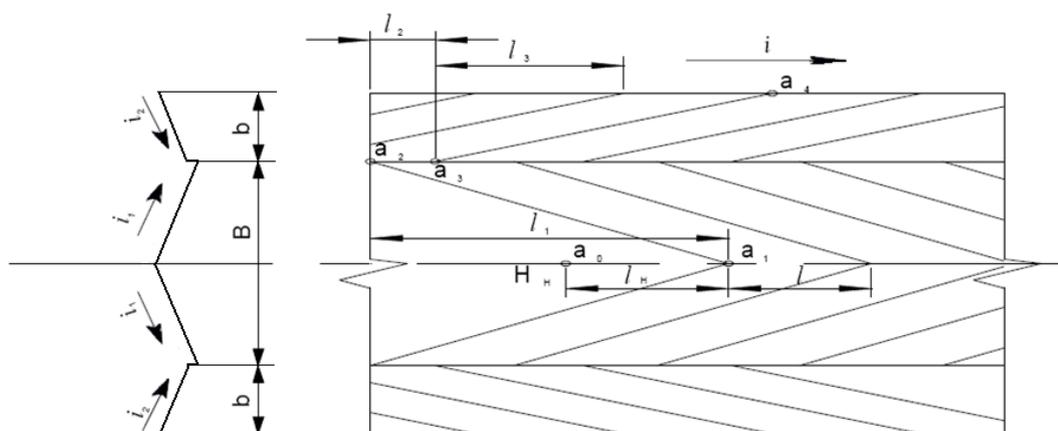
Схема к выполнению вертикальной планировки улицы
